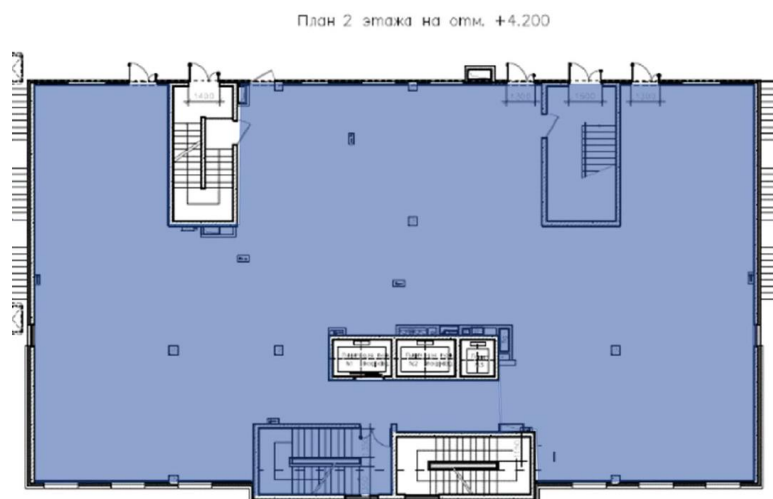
План 2 этажа БС-13 ЖК URAL
